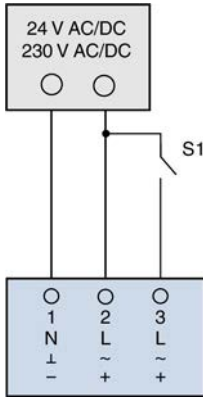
AUF/ZU-Steuerung mit Öffner oder Schließer
